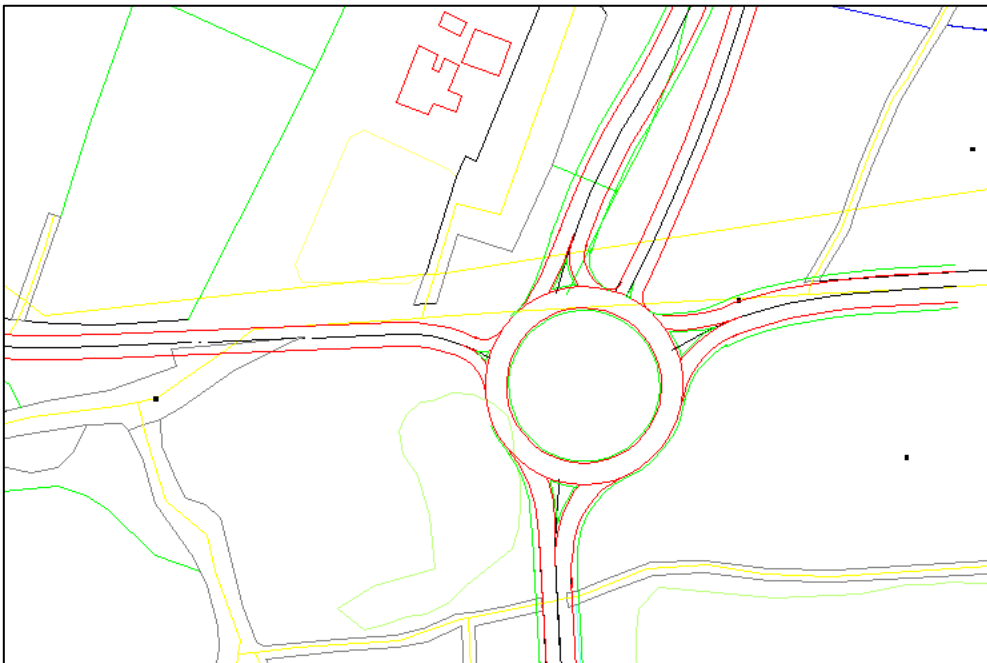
Detalle glorieta final de trazado alternativa C.2
